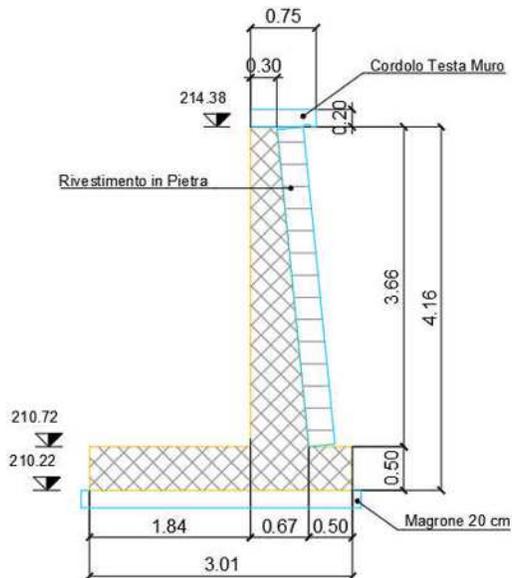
Muro V.OP-02 – Sezione trasversale
